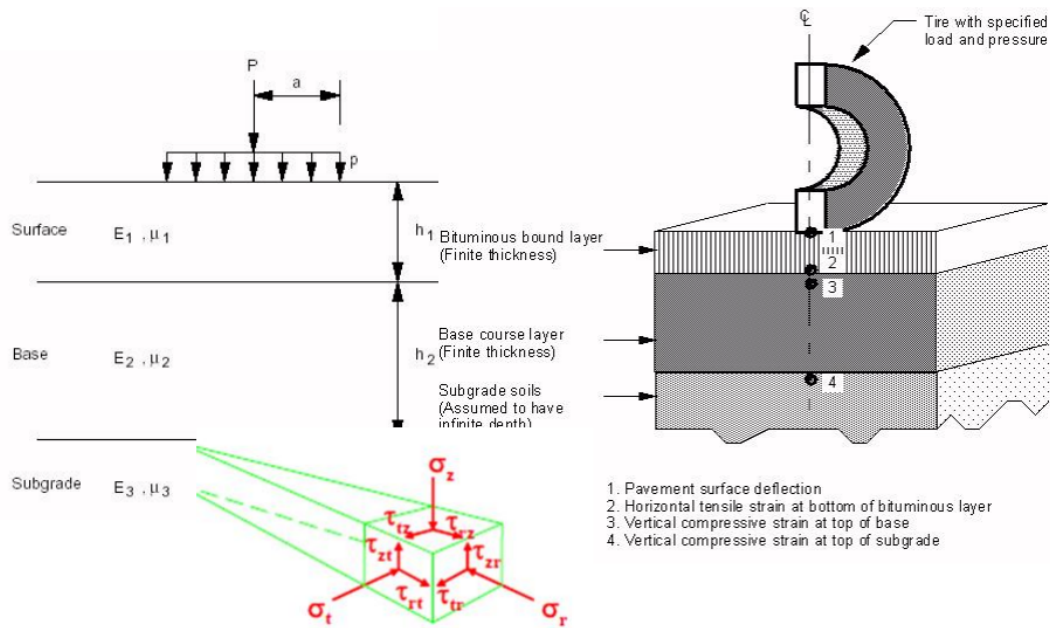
Puntos de análisis de esfuerzos y deformaciones en la estructura del pavimento. Adaptada de Pavement analysis and design [9]
